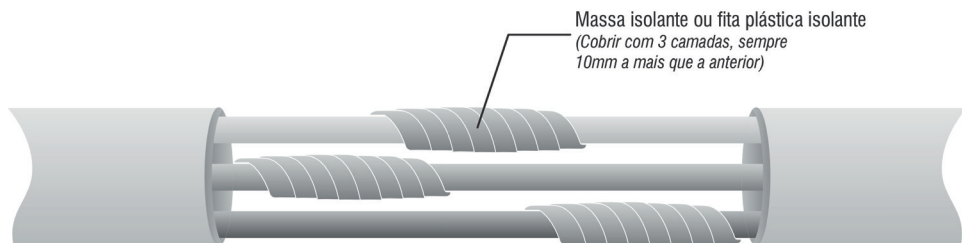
Primeira isolamento: fita plástica isolante ou massa isolante
